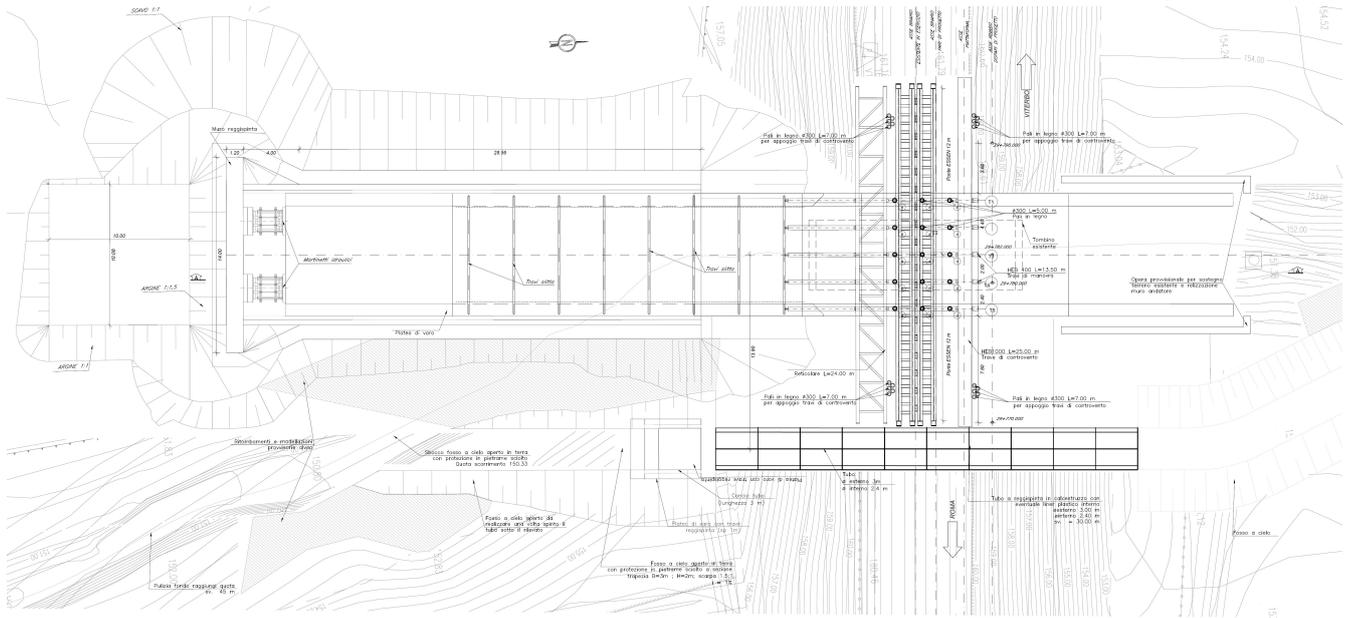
Planimetria dell'area di intervento in fase di varo (vedasi elaborati grafici per dettagli)
